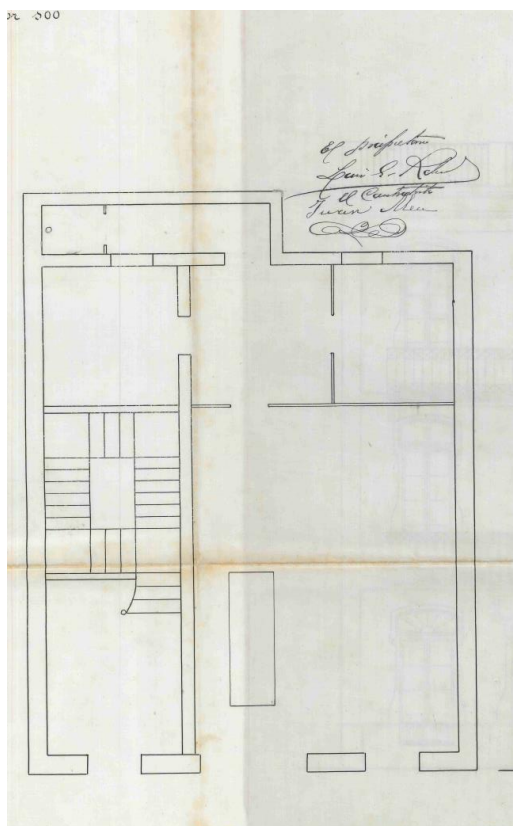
Planos originales archivo municipal de Vilagarcía de Arousa.
